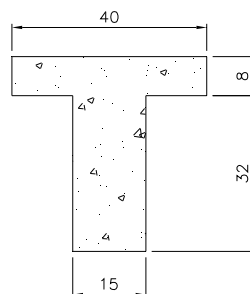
Seção transversal das vigas T (cotas em cm).
